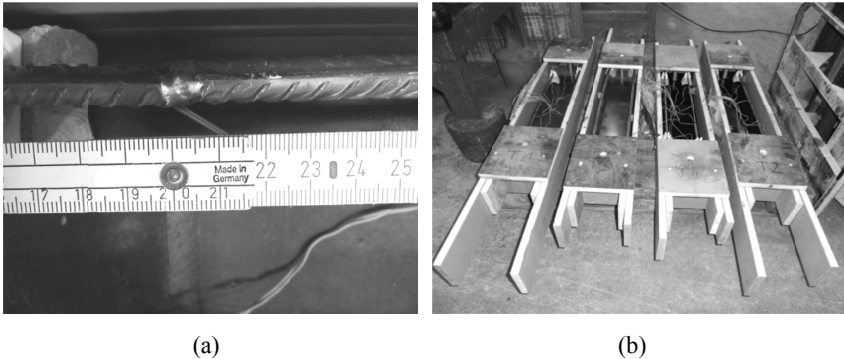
Versuchskörper Tastversuche vor der Betonage: (a) Schweißstumpfstoß Bewehrung und (b) Schalung mit Bewehrung
